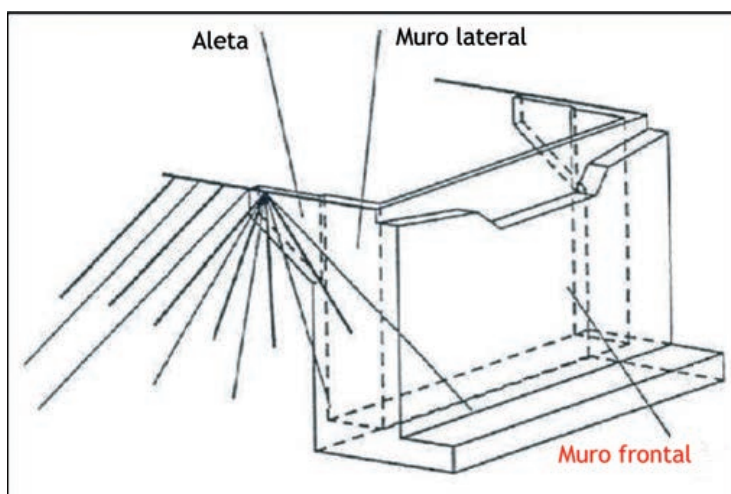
ELEMENTOS DE UN ESTRIBO CERRADO.
